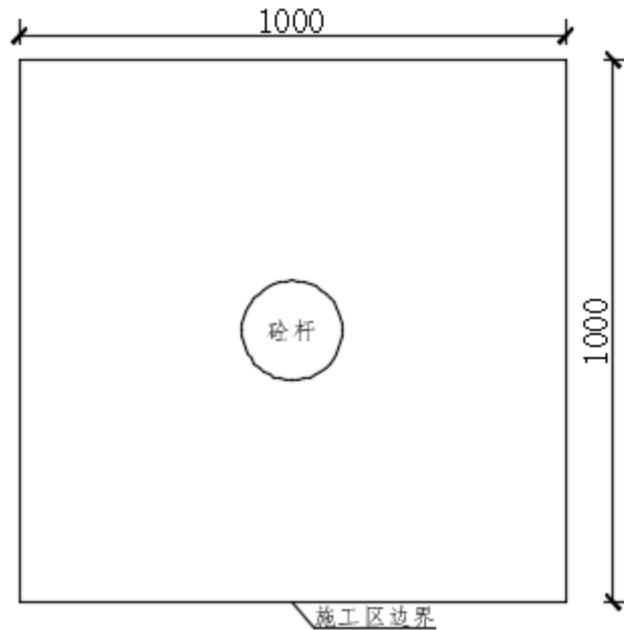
送出线路砼杆施工区平面示意图（单位：cm）
